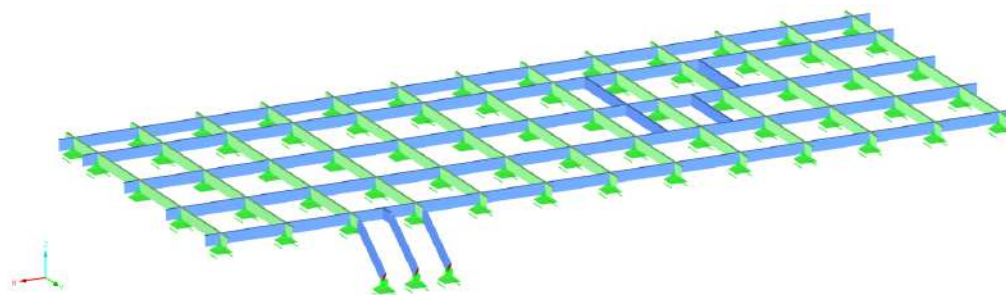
Modelo numérico de cálculo (estrutura principal do Pavimento)
